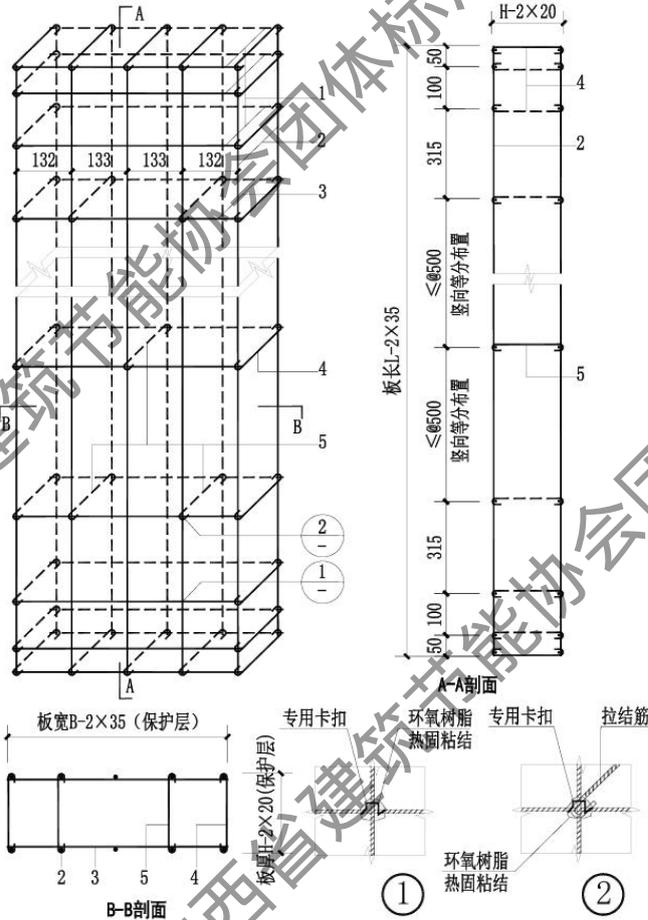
A、C型板增强筋网笼构造示意图 (单位: mm)
